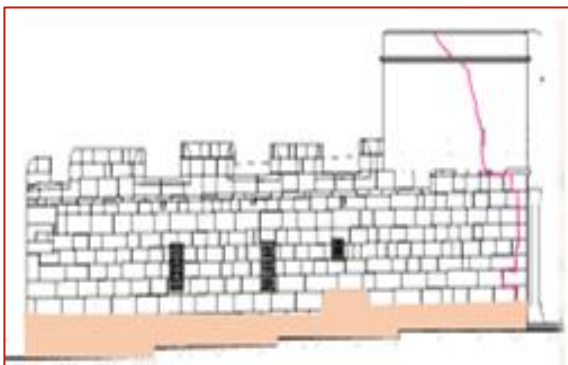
Fissuration au niveau surélévation de la façade ouest
